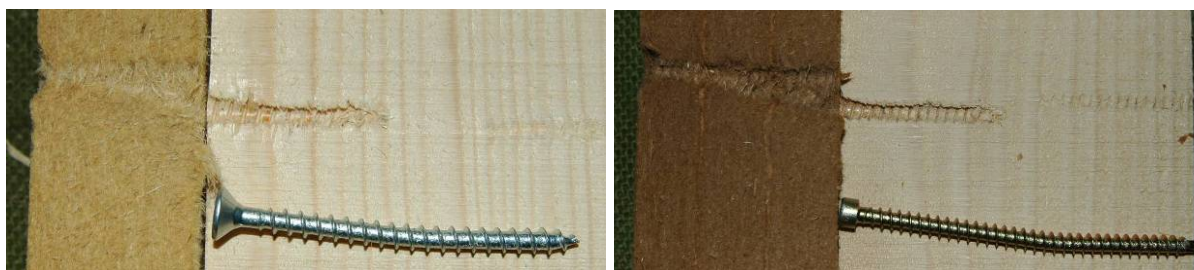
Geöffnete Druckscherkörper einer Holz-HFDP-Verbindung mit Schrauben ohne Halteteller (links: Würth ASSY II 6 x 80 mm, UDP 1_1d_I; rechts: Würth ASSY VG 6 x 100 mm, UDP 3_d_I)
